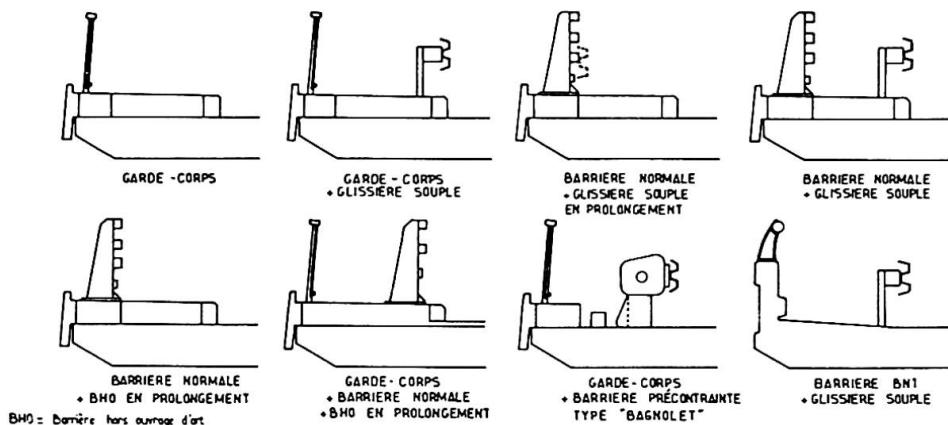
Dispositifs de protection de la voie ferrée aux croisements fer-route.
